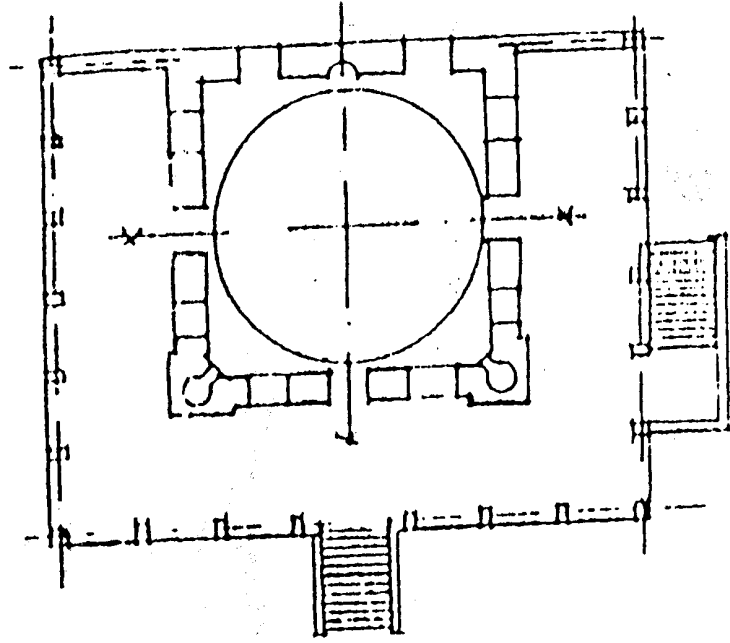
مسقط أفقي للبكرية بصنعاء اليمن (عن : Serjnet)
